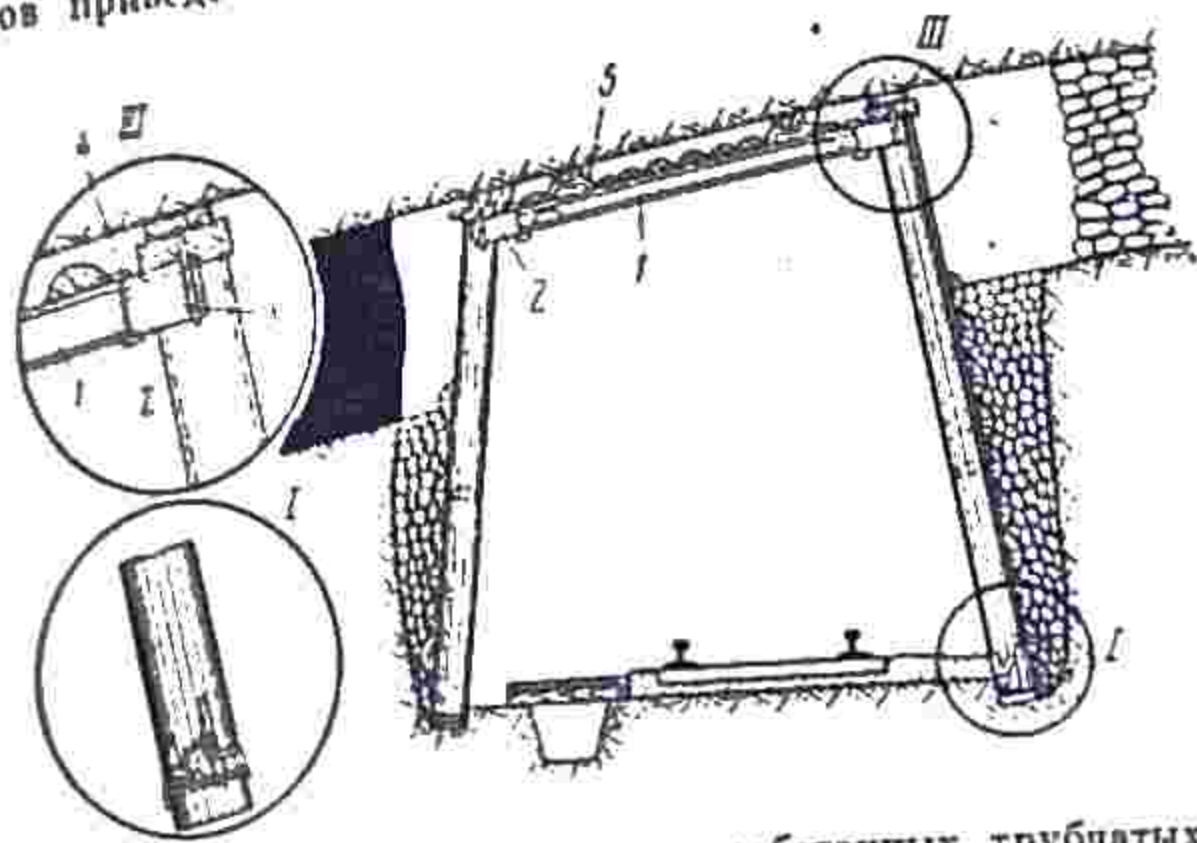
Податливая крепь из железобетонных трубчатых стоек
